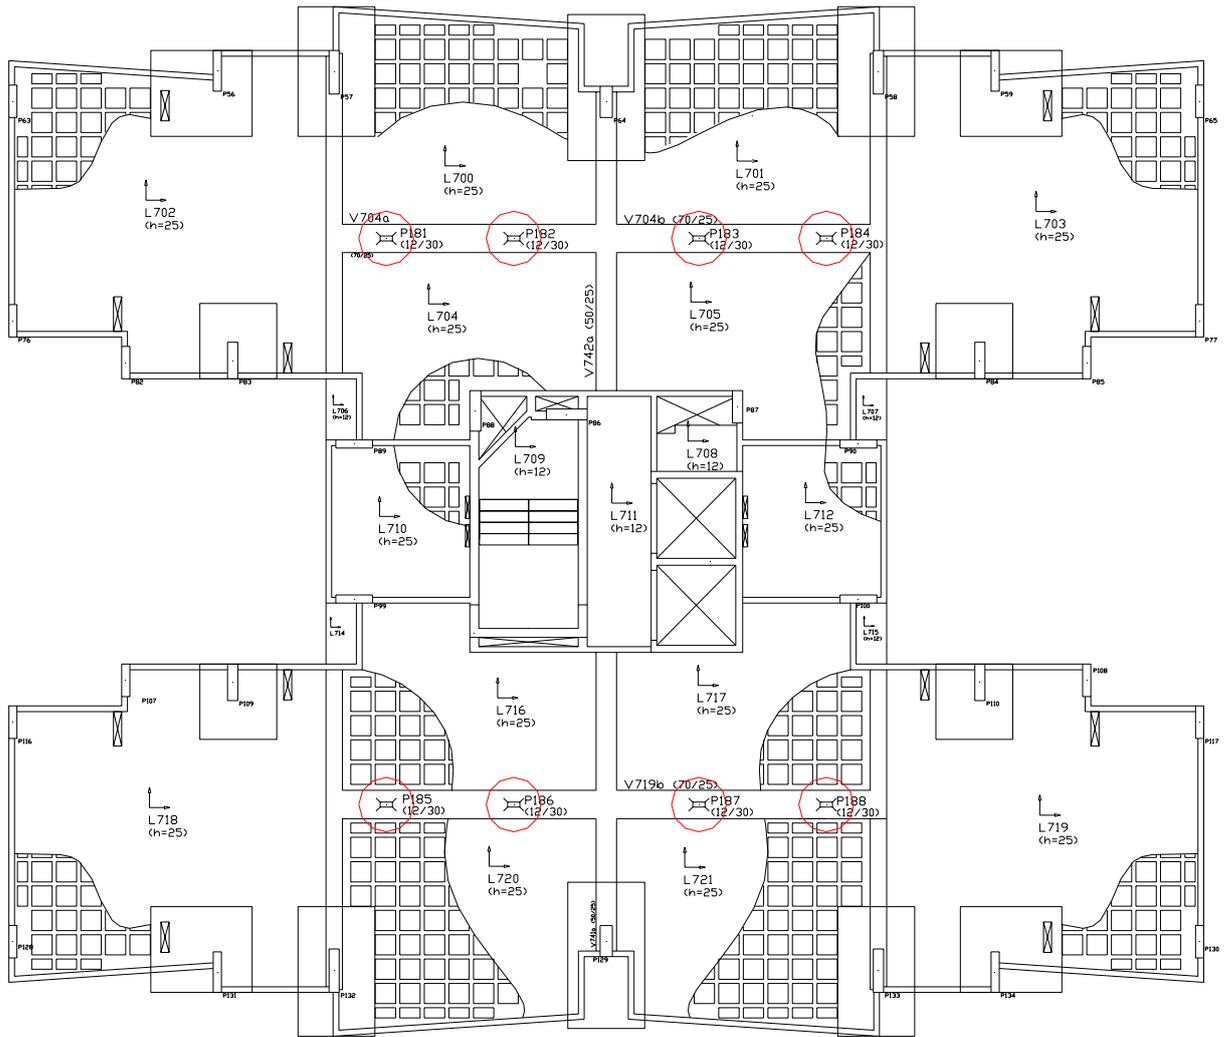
Planta baixa do pavimento 15 do Edifício 04, com destaque para os pilares que nascem neste pavimento
